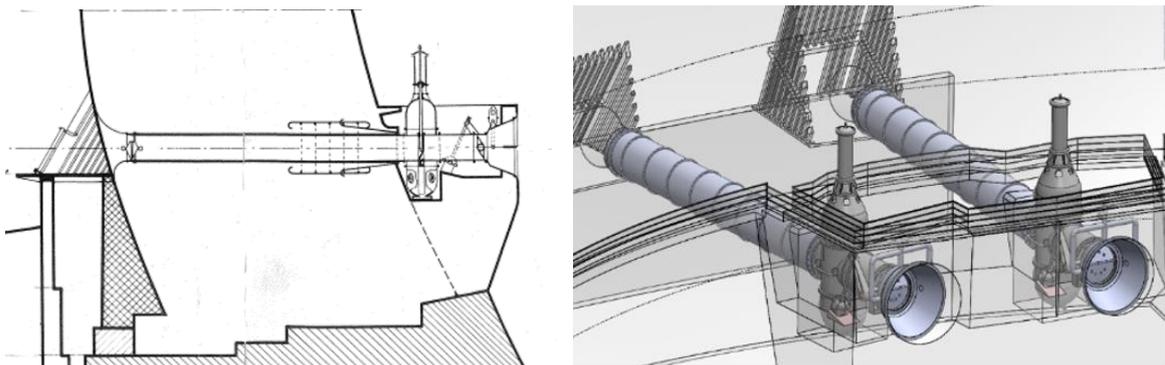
Vue en coupe et vue iso des dispositifs de vidange d'origine
